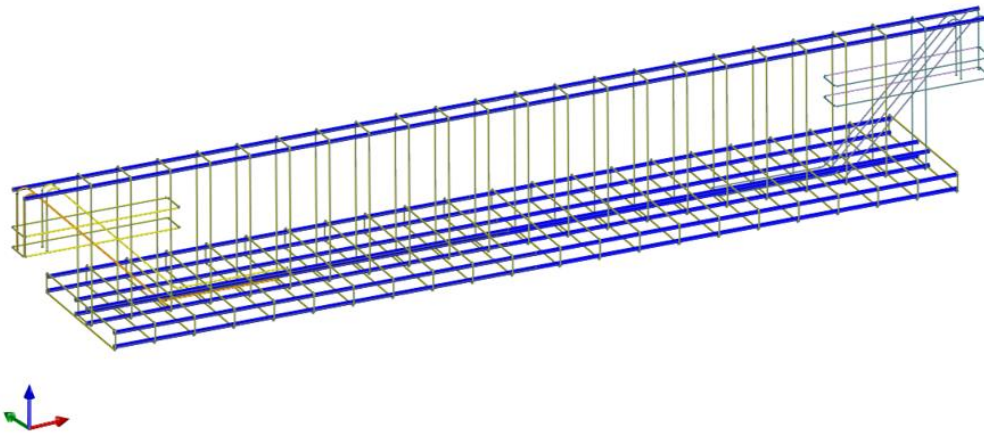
Modello geometrico armature, trave schema B, vista 3D
